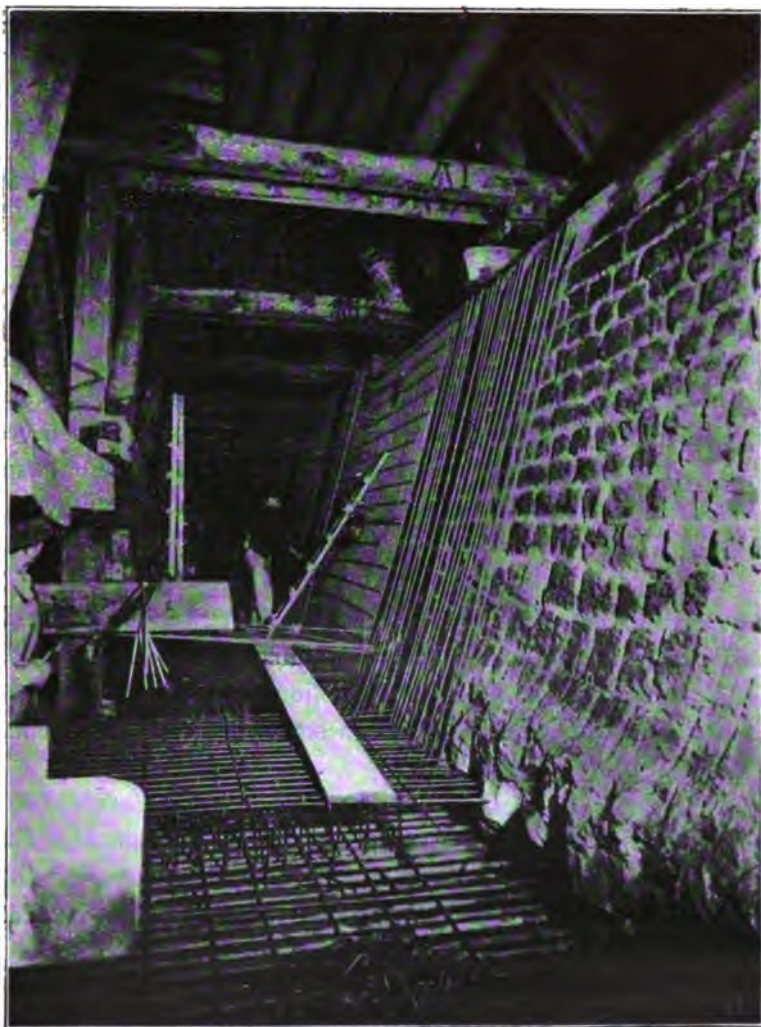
Confection de la bache en béton armé du canal Saint-Martin.
